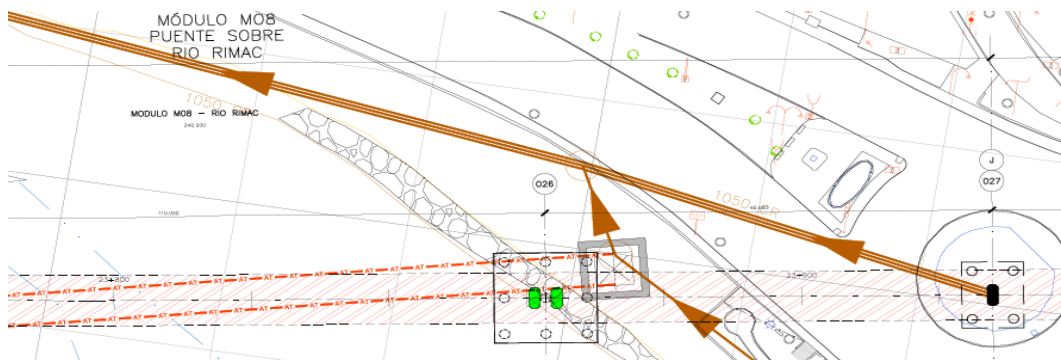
Pilotes en puente Sobre El río Rímac
